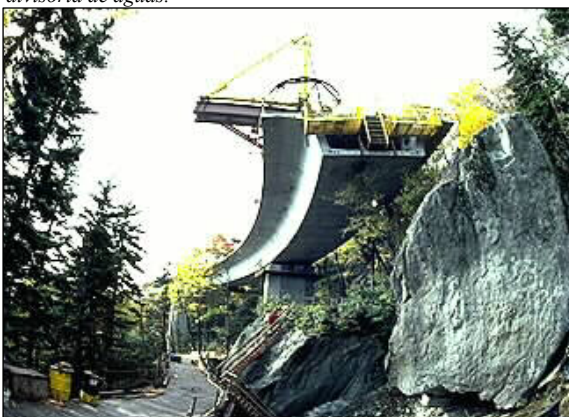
Vista inferior del viaducto en construcción . Fuente: <http://www.grandfather-mountain.com/BRParkway/Figg.htm>
